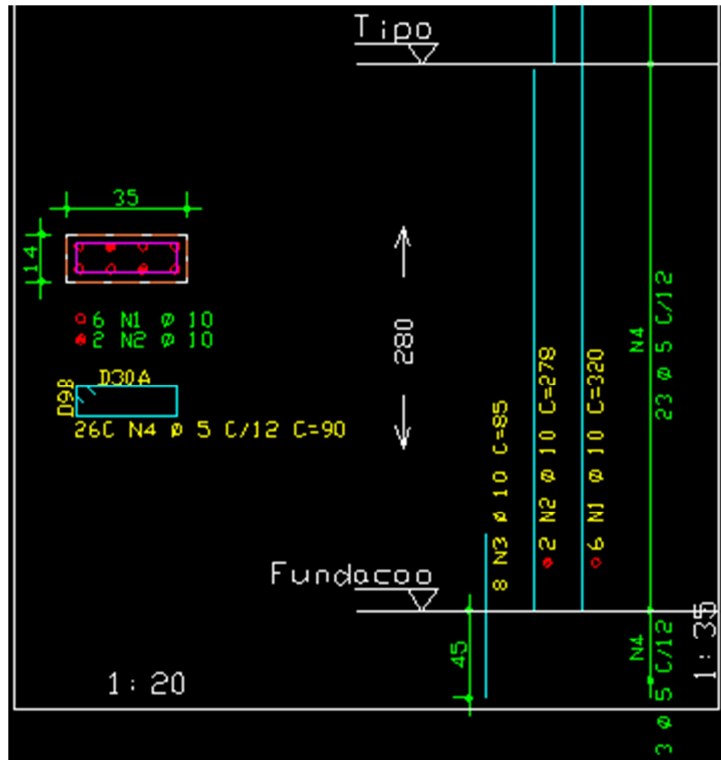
Detalhamento das armaduras de aço do Pilar 6 após da aplicação do SISE.
